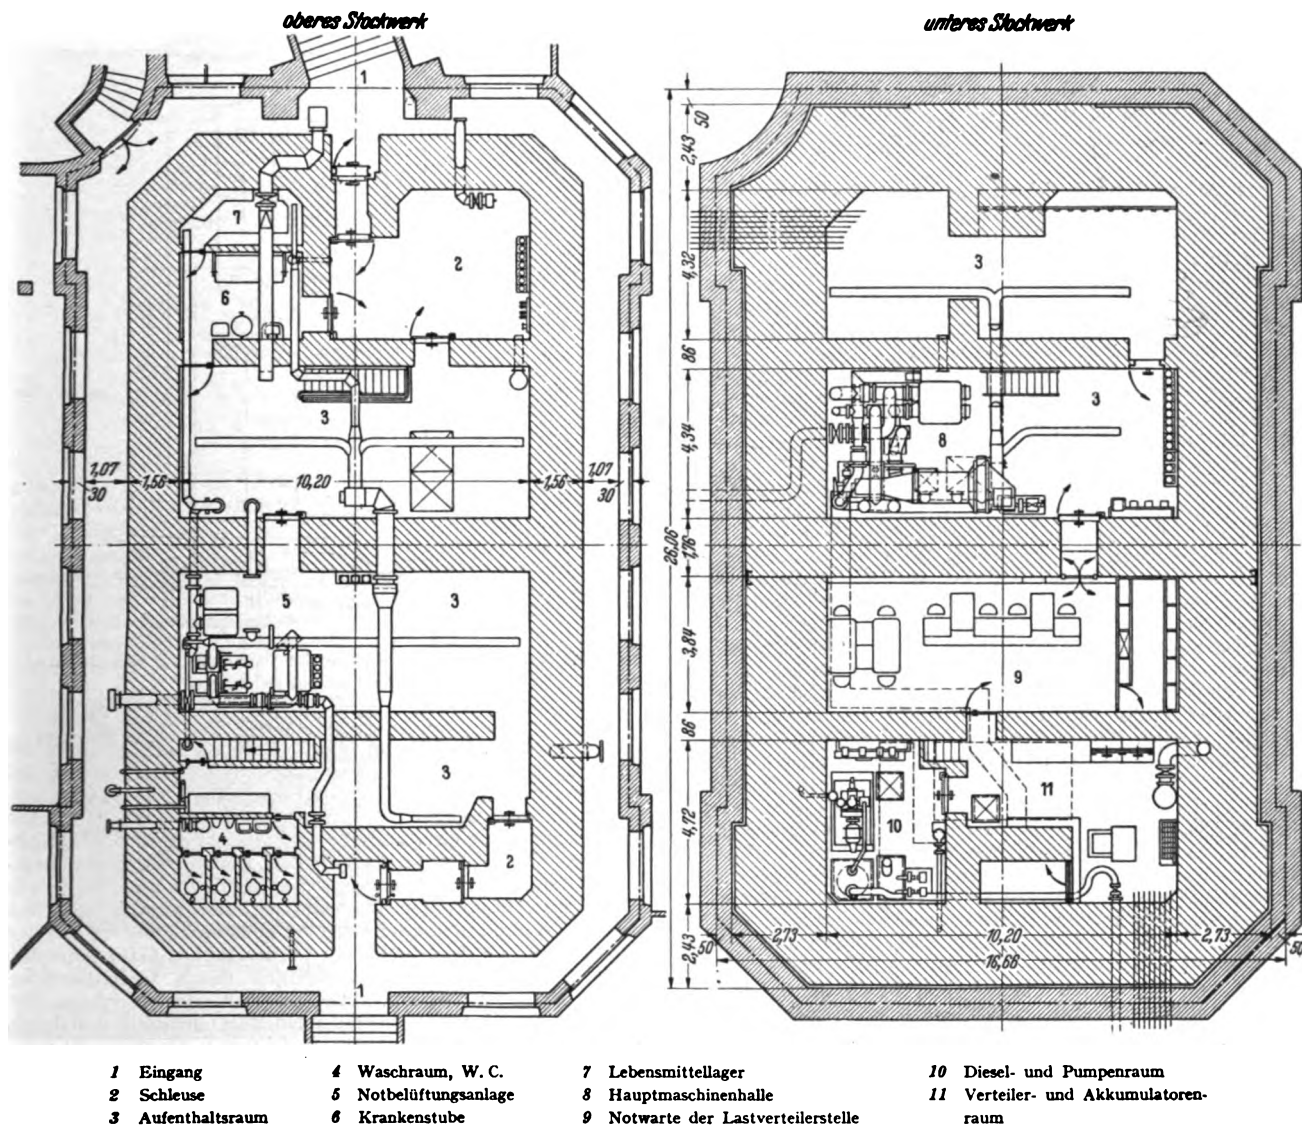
Grundrisse des zweigeschossigen Luftschutzraumes der Lastverteilerstelle in Paris.
